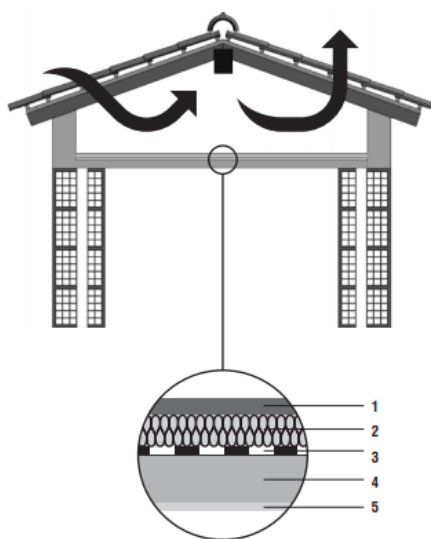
Esquema de cobertura com desvão ventilado e isolamento na laje horizontal
